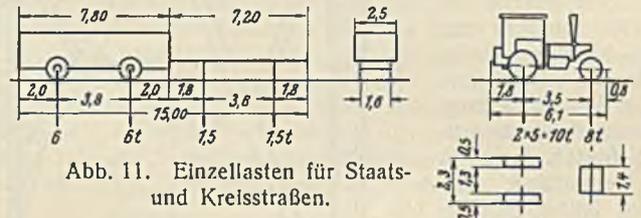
Einzellasten für Staats- und Kreisstraßen.
